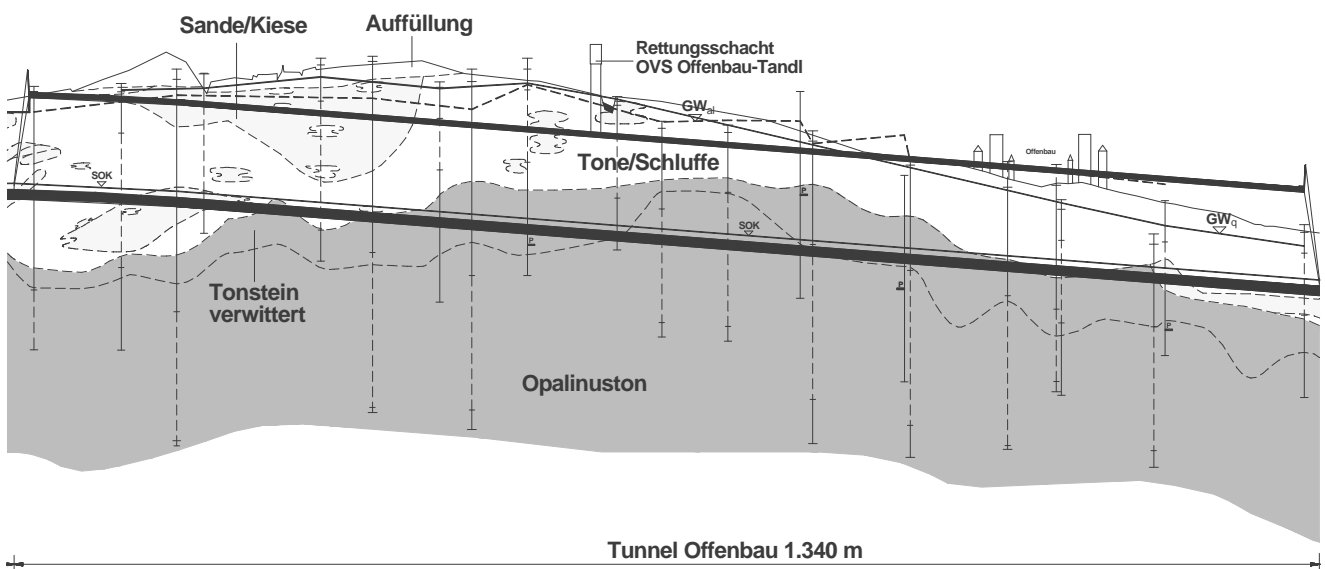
Geotechnischer Längsschnitt Tunnel Offenbau
